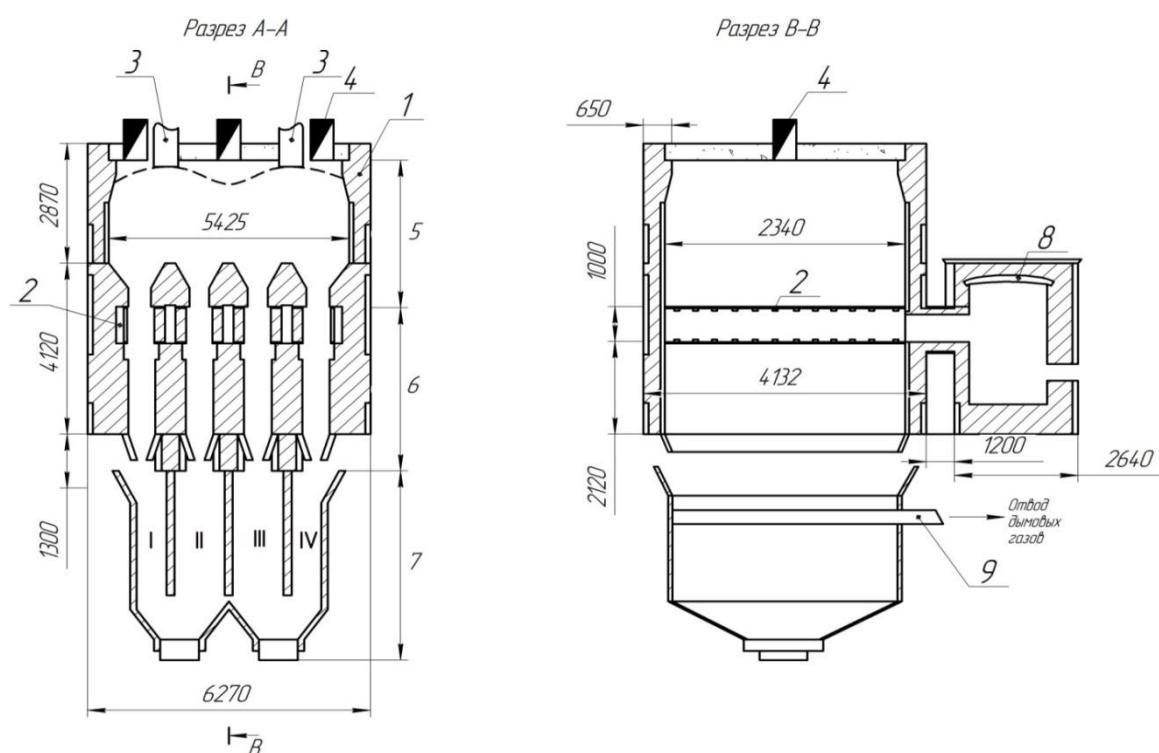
Схема вертикального разреза шахтной печи для обжига сидеритовой руды: 1 – шахтная печь; 2 – керны с жаровыми каналами для подачи теплоносителя; 3 – патрубки загрузки шихты; 4 – короба для отвода дымовых газов; 5 – подогревательная зона печи; 6 – зона охлаждения 1; 7 – зона охлаждения 2; 8 – топка, 9 – отвод газов из зоны охлаждения 2; I, II, III, IV номера бункеров зоны охлаждения 2
